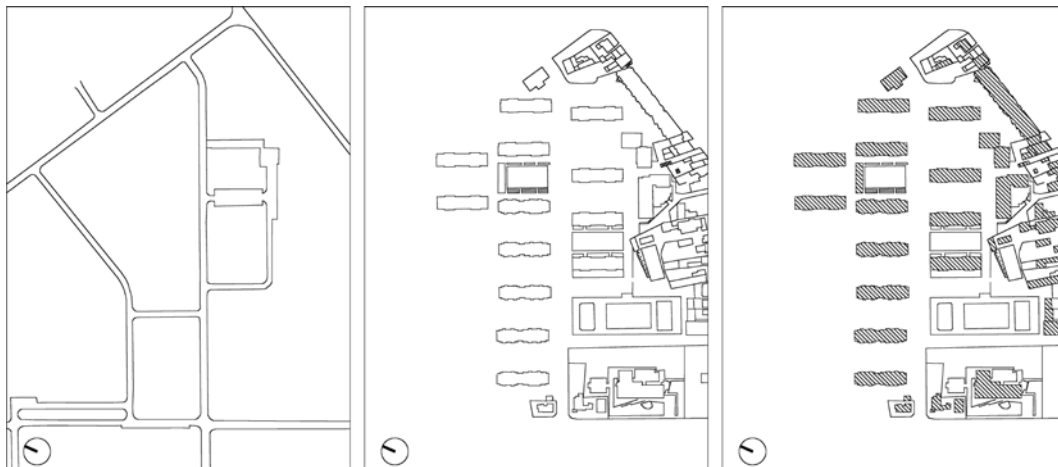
PLANTA DO BAIRRO EM 1986.
